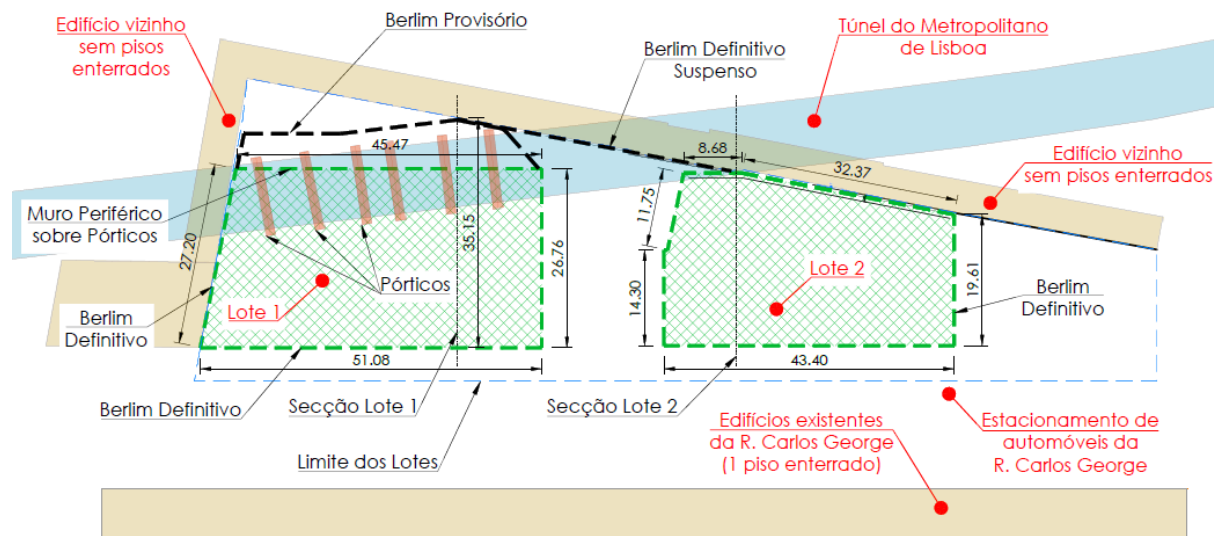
Planta de implantação esquemática dos lotes 1 e 2 (Adaptado de JET_{SJ}, 2021).
